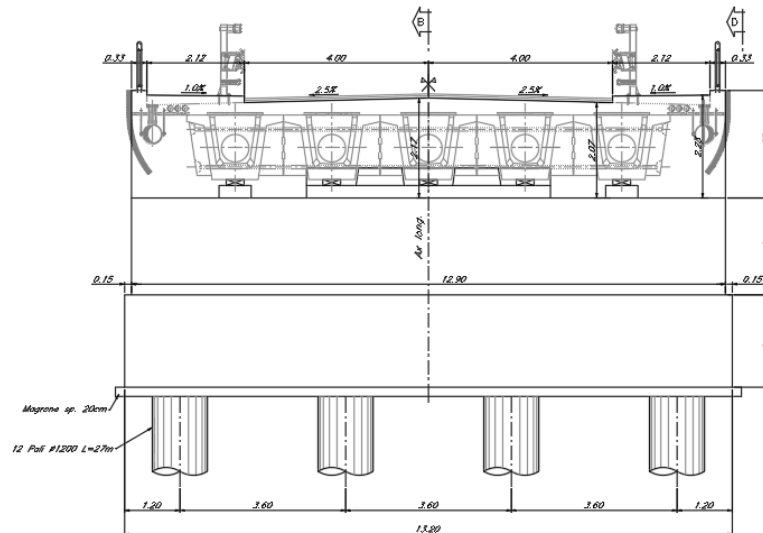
Spalla B – Pianta fondazioni
